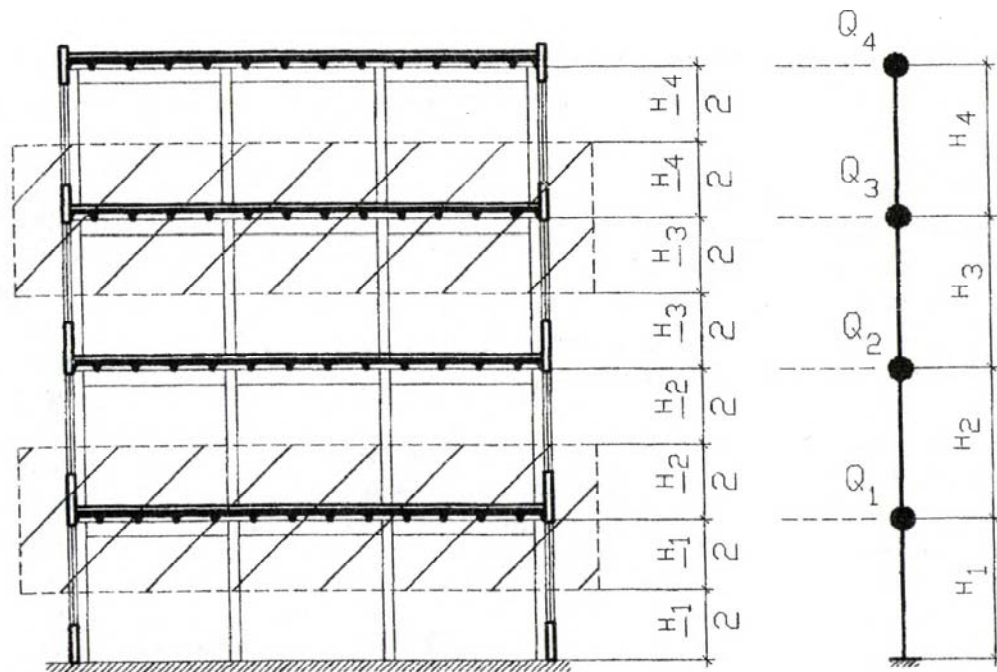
Формирование динамической расчетной схемы каркаса многоэтажного здания
